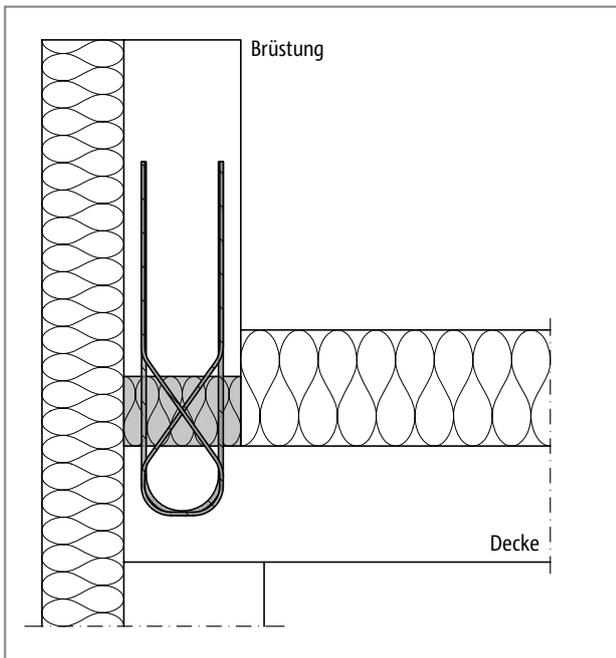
Schöck Isokorb® Typ ABXT vertikale Anordnung: Anschluss einer Attika
